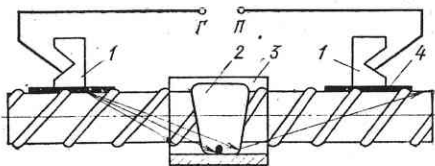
Схема ультразвукового контроля сварных соединений арматуры периодического профиля:
